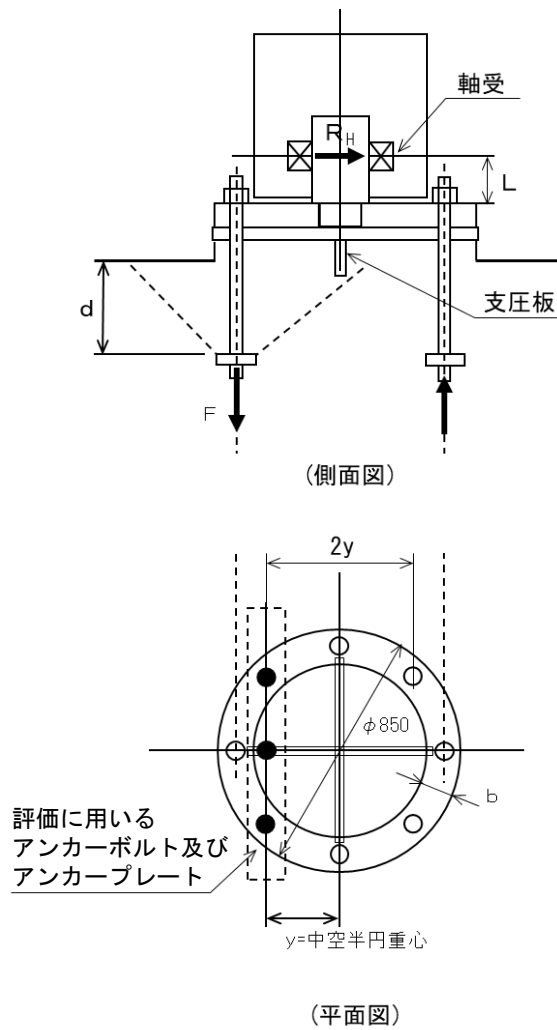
下部支承 (アンカーボルト) 及び下部支承 (コンクリート) の評価イメージ図
